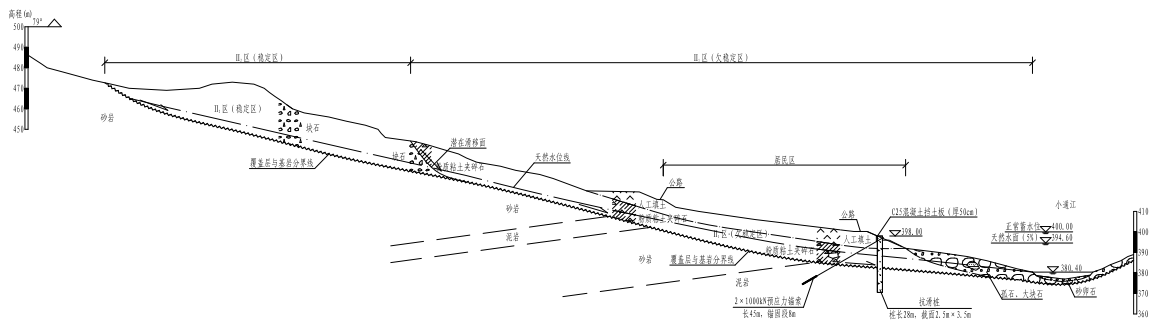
滑坡治理典型断面图（抗滑桩支挡方案）
